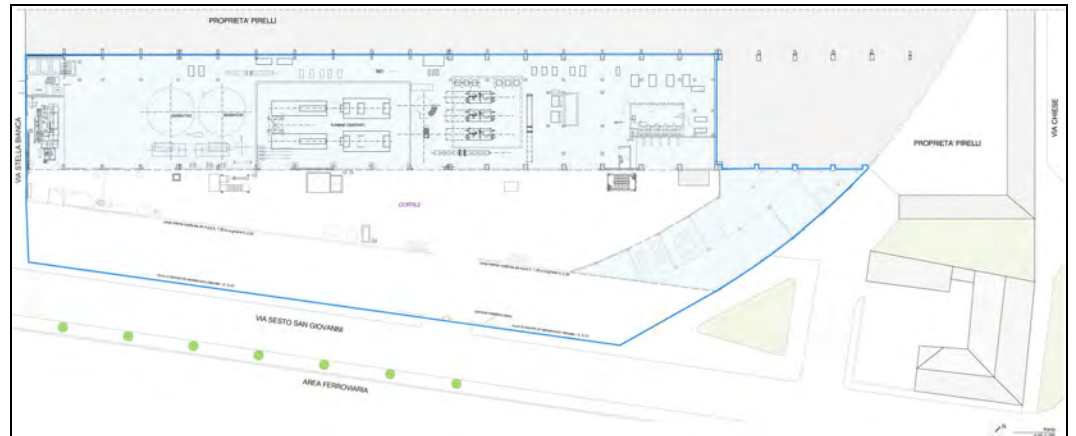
Estratto tav 01 – Pianta (stato di fatto)
